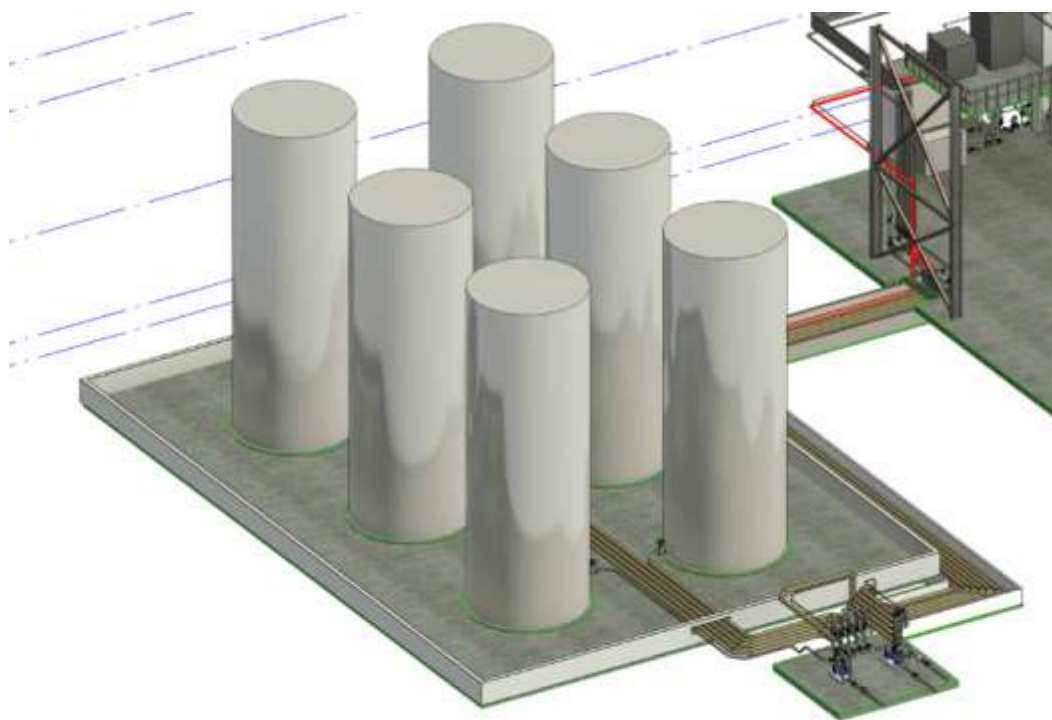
Модель ловушечной ванны резервуарного парка
